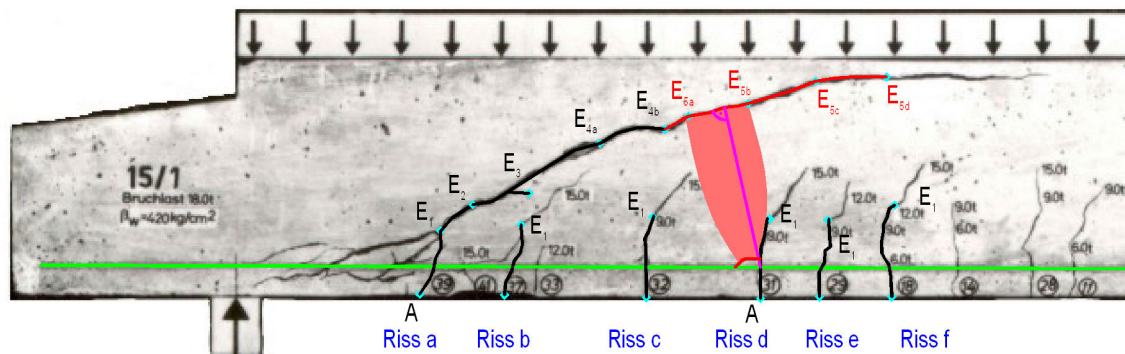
Ausschnittsvergrößerung des Balkens 15/1 aus [2.4] mit Kennzeichnung der Rissabschnitte A - E_{5d} im Zustand II.5
